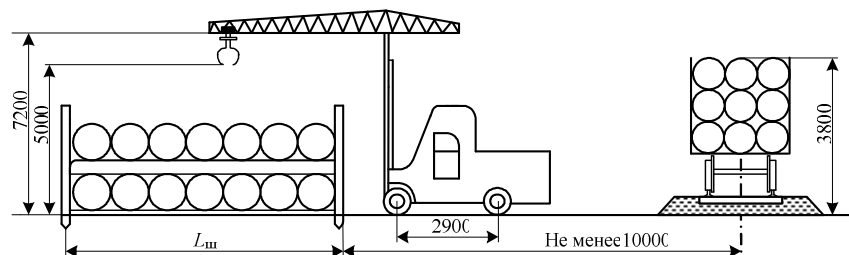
Схема механизированной погрузки, выгрузки круглого леса автопогрузчиком с грейферным захватом
